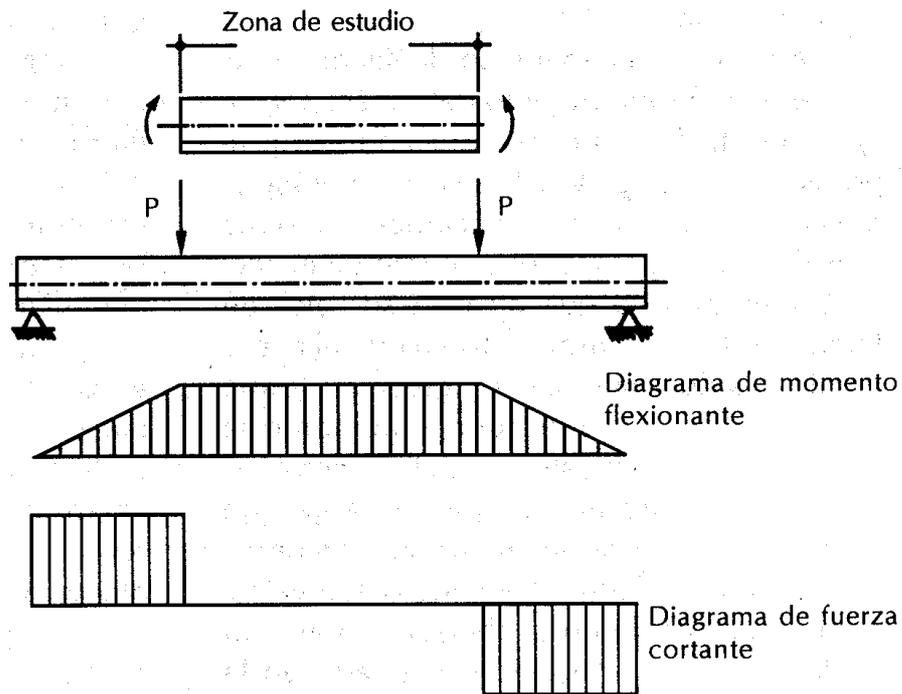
Espécimen típico para estudio de flexión simple.
